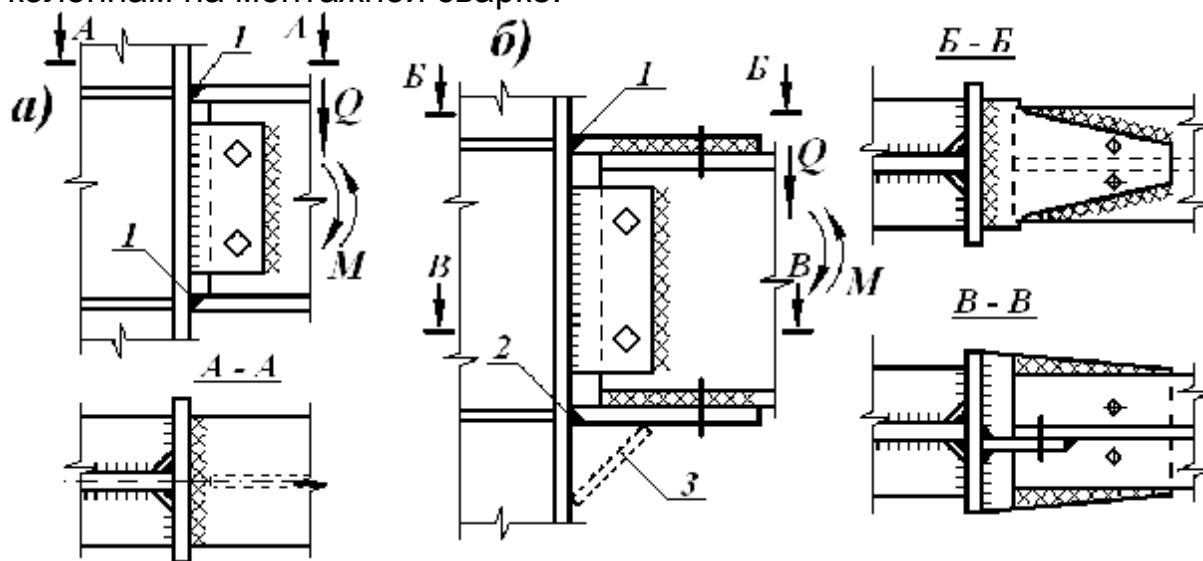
Жесткое прикрепление балок к колоннам на монтажной сварке. 1 – монтажный сварной шов; 2 - заводской сварной шов; 3 – подкос из листа.
